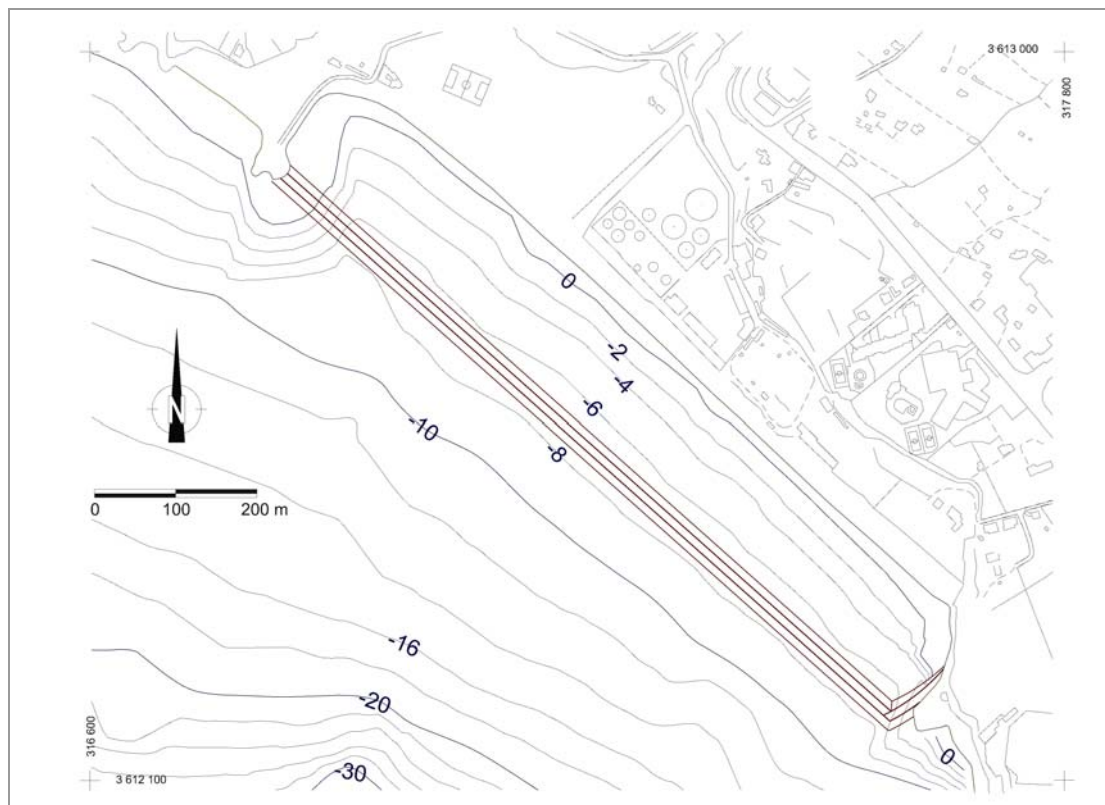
Planta da configuração das estruturas da solução B para a nova praia.
